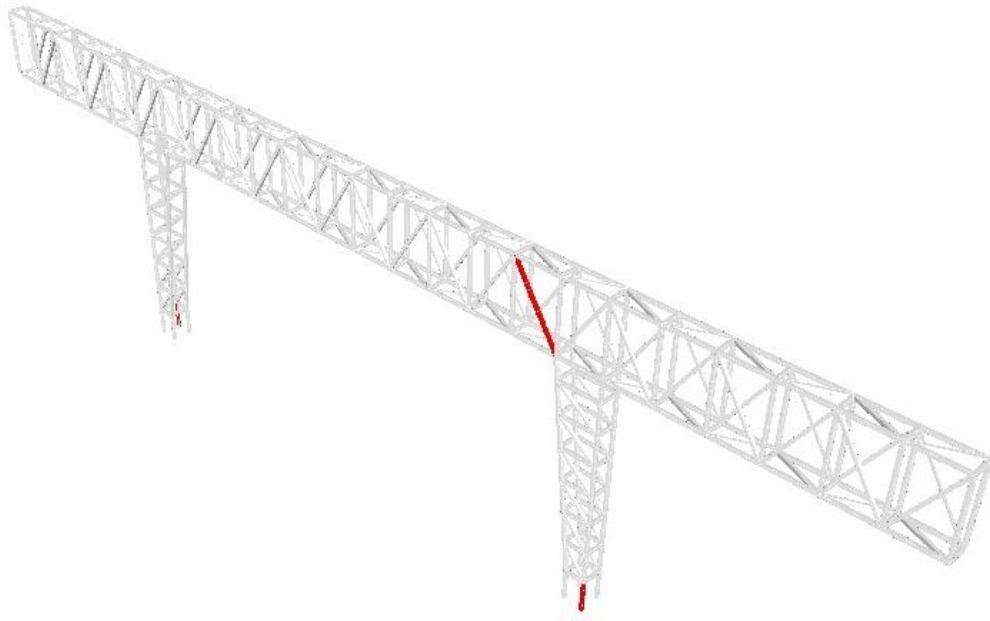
| *Barras consideradas del pórtico intermedio
